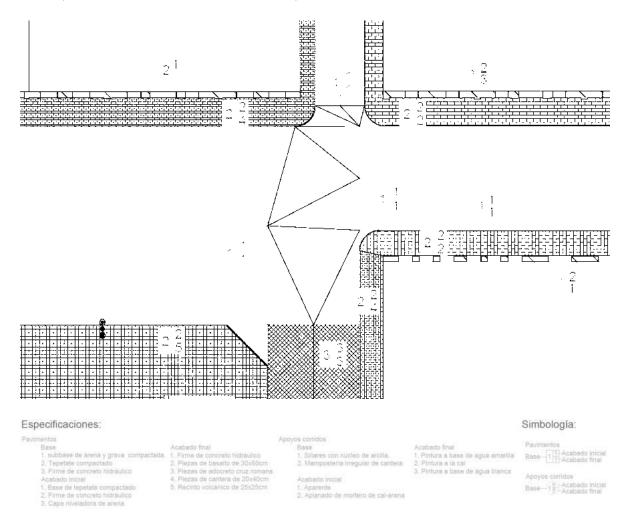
Planta de materiales y sistemas constructivos. Fuente: elaboración propia.
